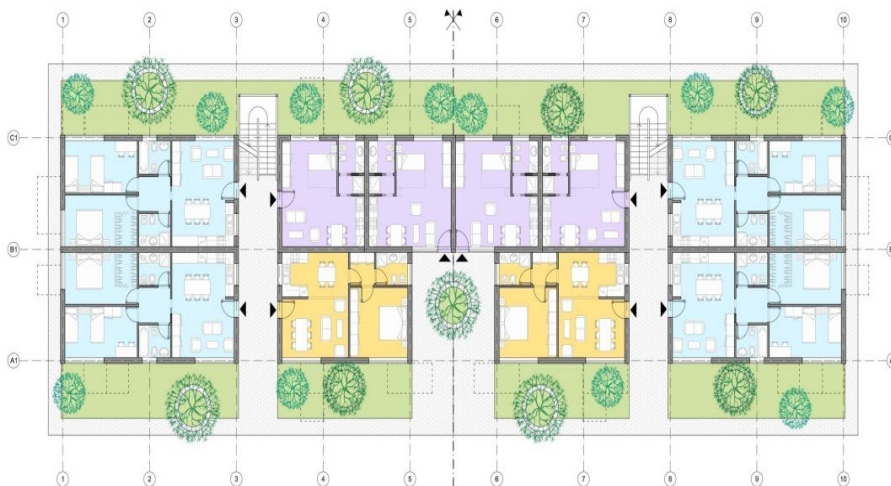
Pianta tipo piano terra progetto C.A.S.E., 10 alloggi per 24 posti letto.⁴³
